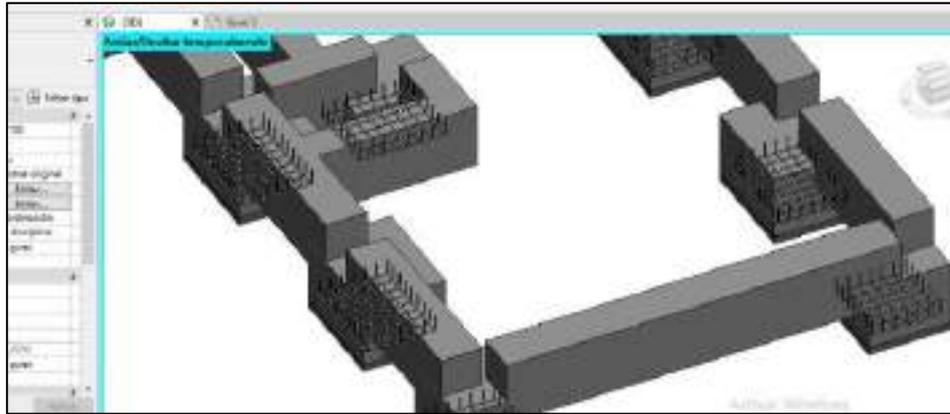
Modelamiento del acero de las cimentaciones y zapatas del edificio.
